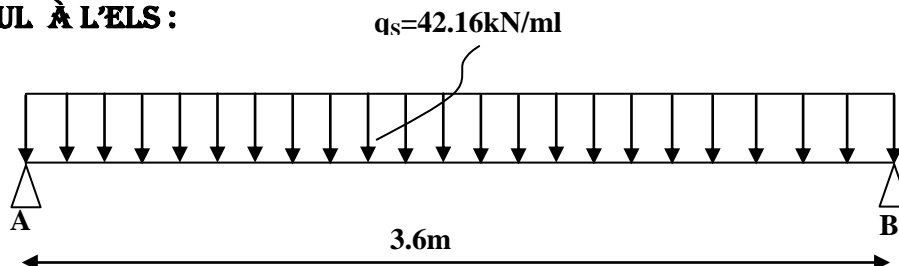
Schéma statique de la poutre palière a l'ELS
